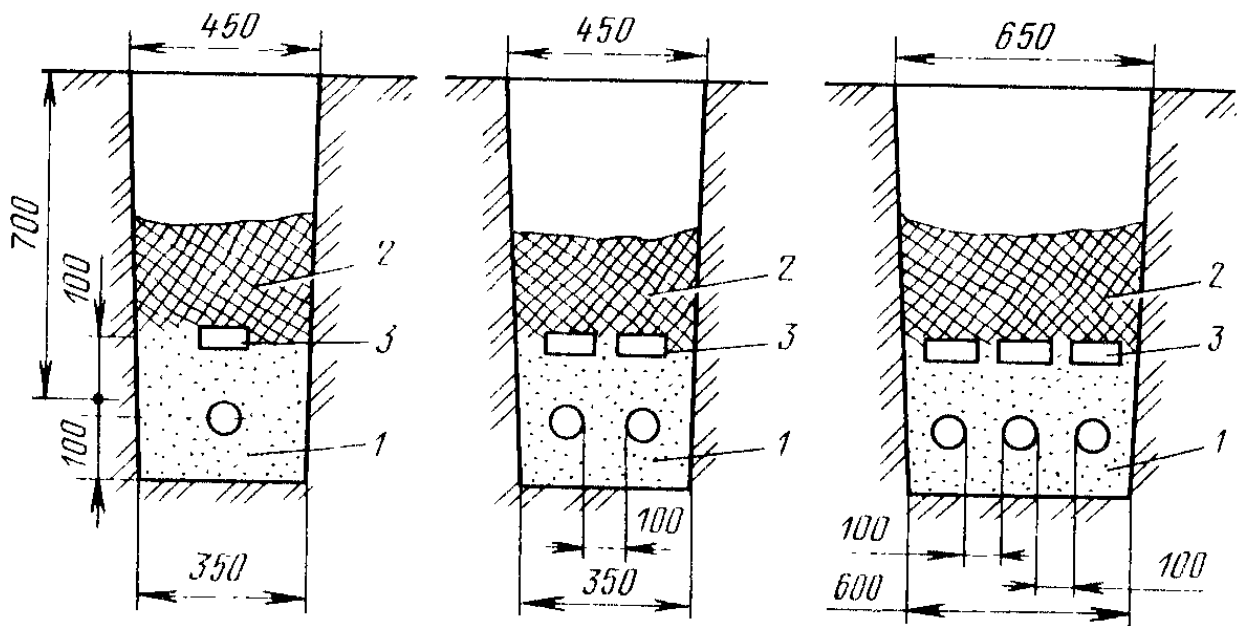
Переріз траншеї для прокладки кабелю напругою до 10 кВ: 1 – пісок або просіяна земля; 2 – ґрунтова земля; 3 – цегла
